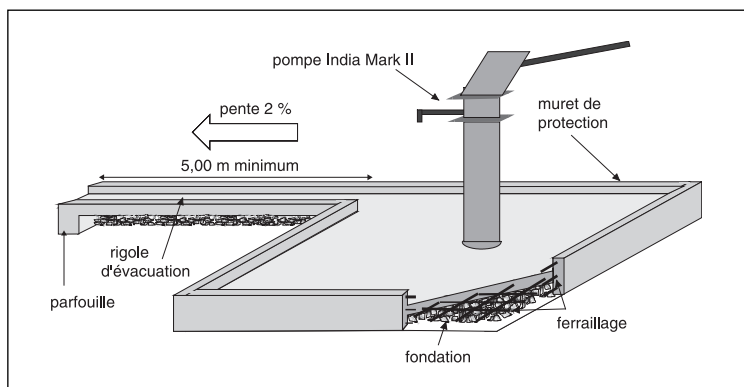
Principe de l'aménagement de surface (ACF Ouganda, 1996).
